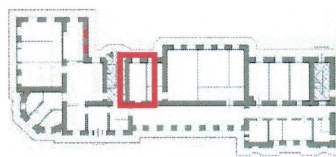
Междуэтажные плоские перекрытия, кирпичные перемычки оконных, проемов
